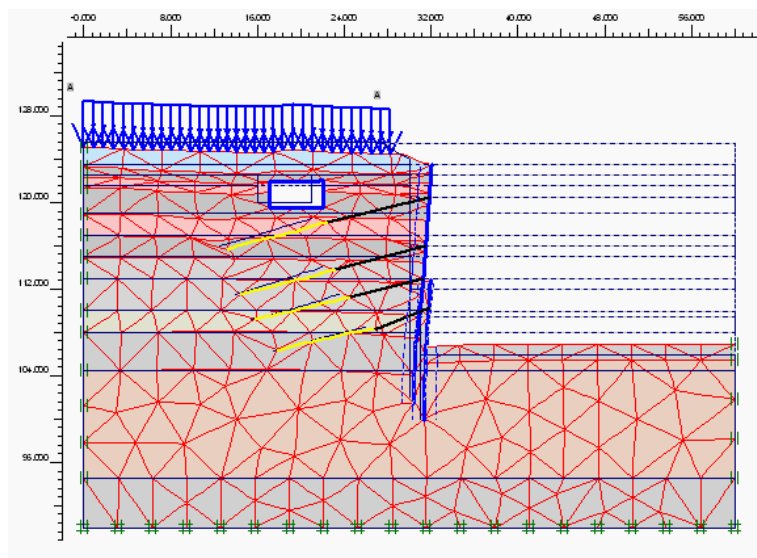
Деформированная схема ограждения котлована с многоярусным креплением при расчете методом конечных элементов.
